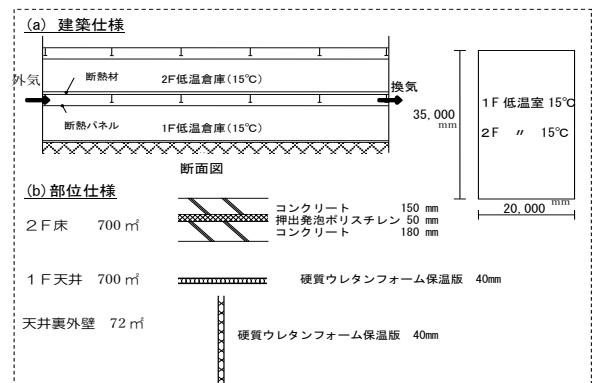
建物モデル (低温室天井裏) (Building Model (Behind The Ceiling of The Low-temperature Room))
